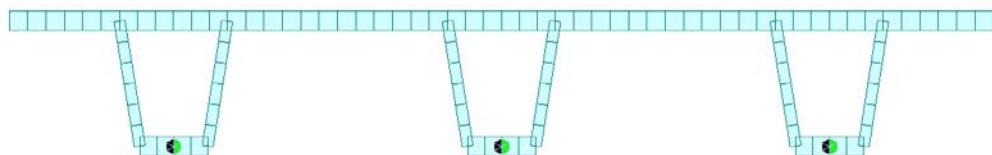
Modello FE sezione trasversale - Vista trasversale estrusa
